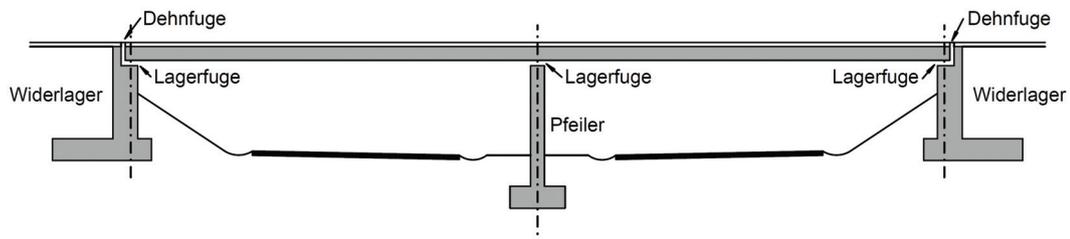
Konventionelle Brücke mit Lager- und Dehnfugen [2 S. 2]
